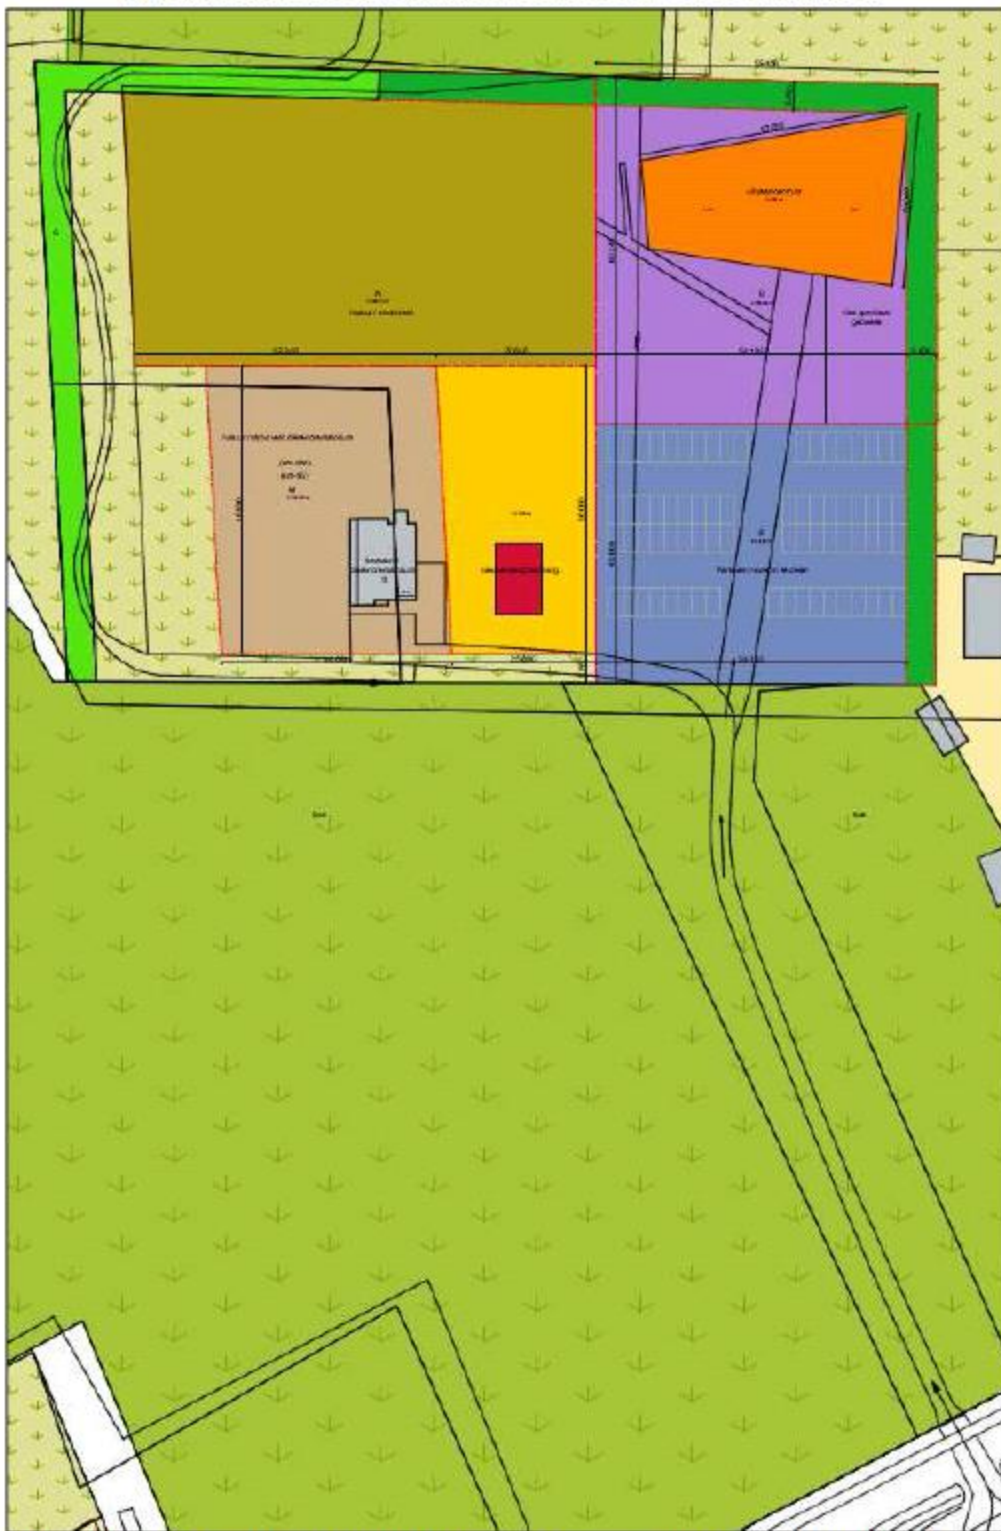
Inrichtingsschets eerder beoogd dierenpension en uitsnede vigerend bestemmingsplan met bestemming 'Bedrijf'
